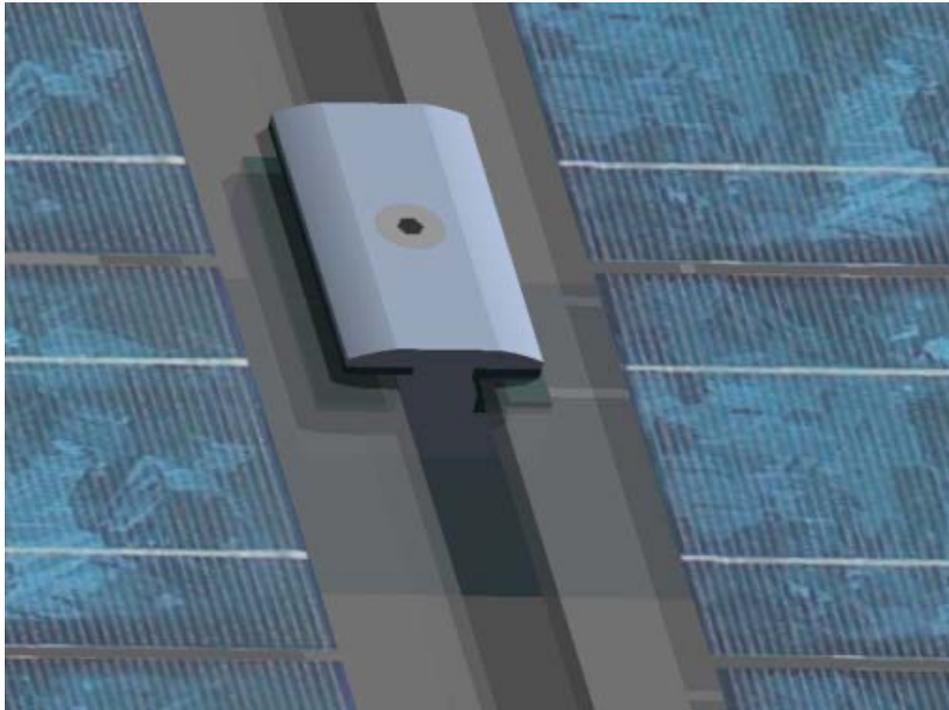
Unterkonstruktion mit Montageschienen
